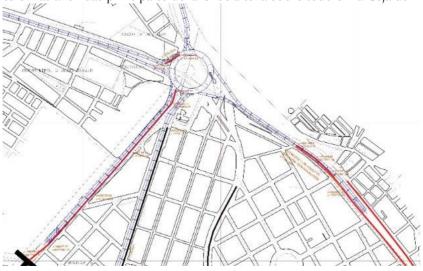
SISTEMA PLUVIAL EXISTENTE ROTONDA
